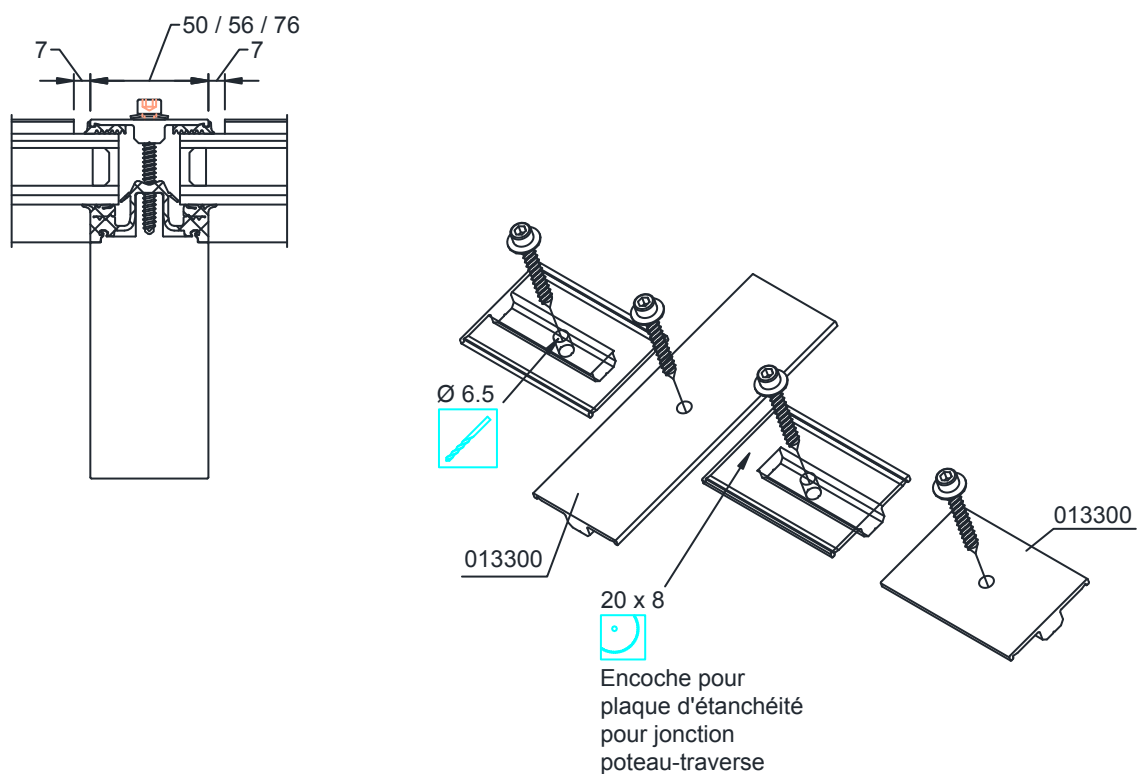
Découpe et usinage des profilé de serrage : serreur plat de 3 mm en chevrons et traverses
